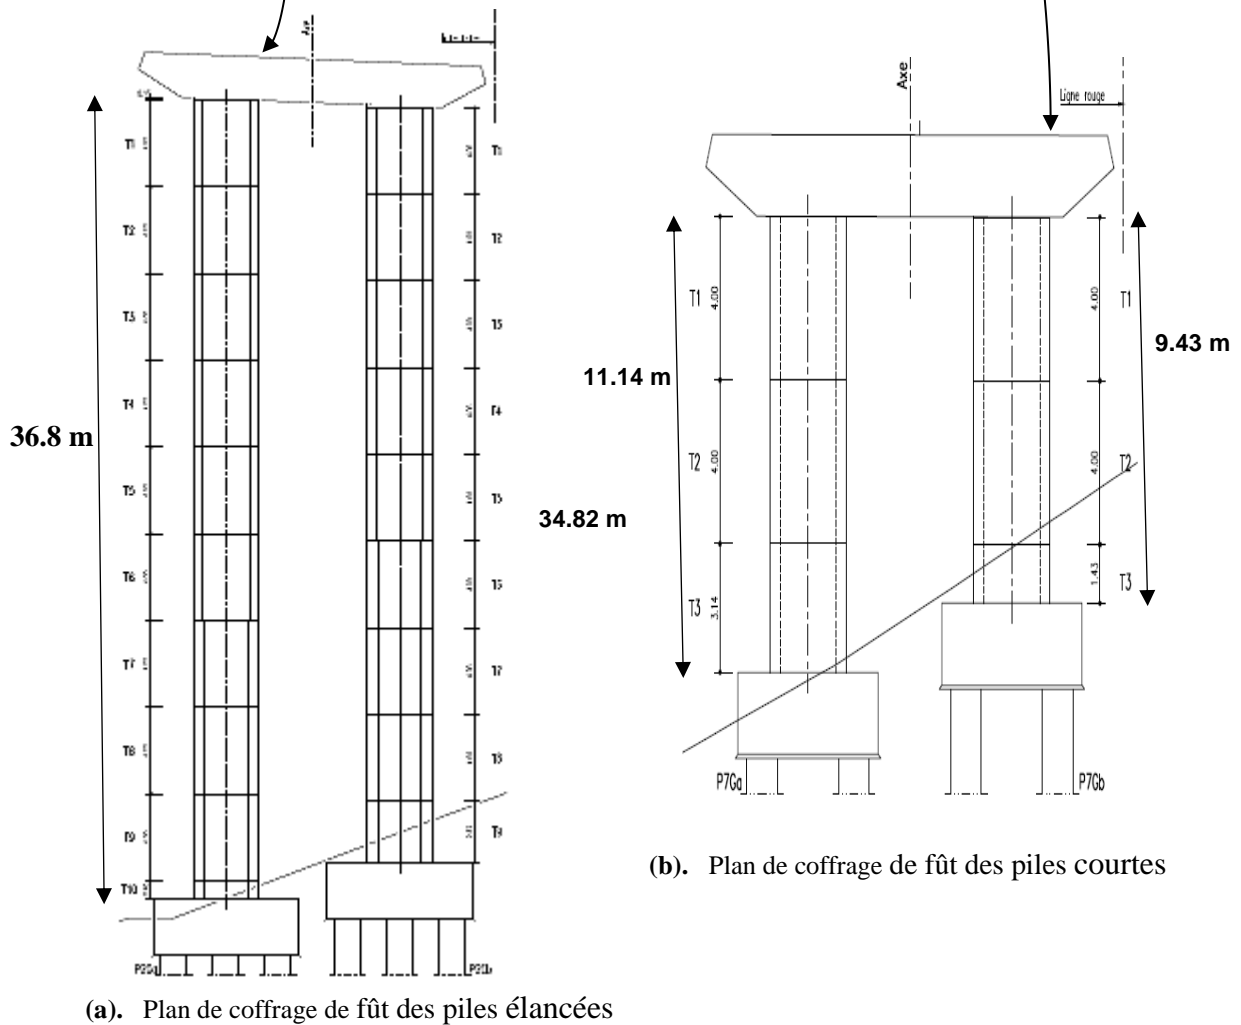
Plan de coffrage de fût des piles élancées et de fût des piles courtes (coupes transversales) [43]
